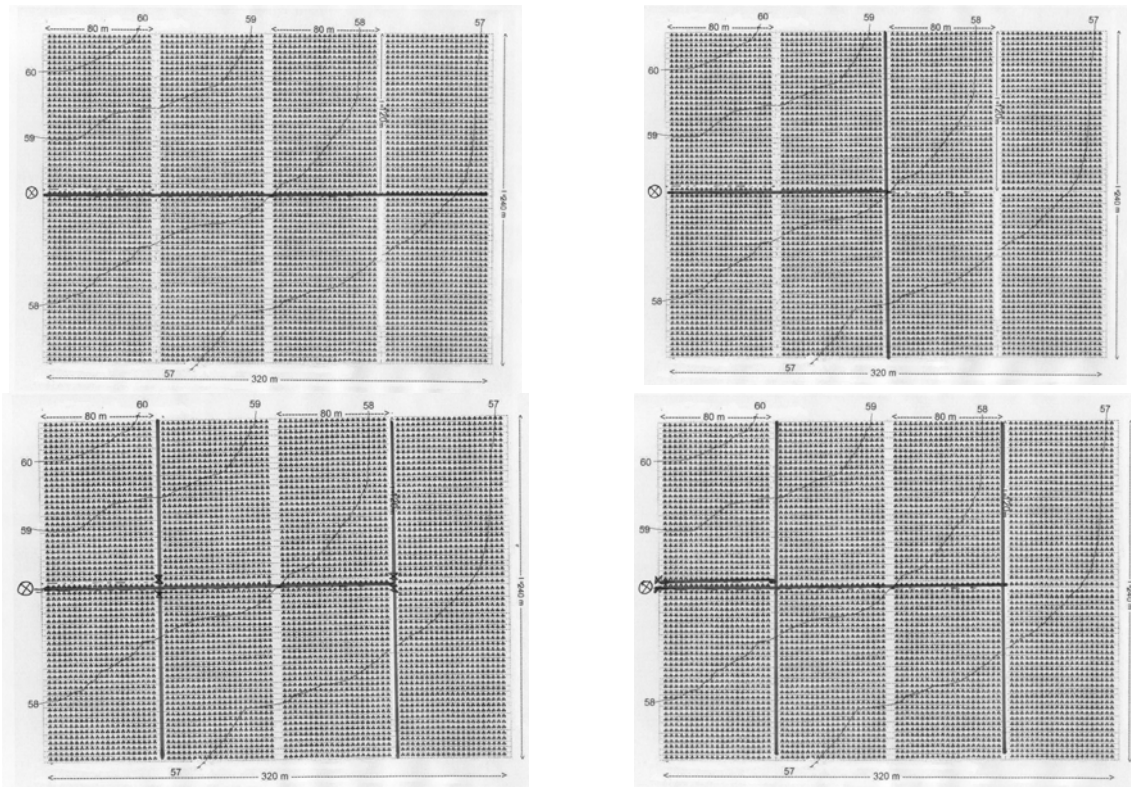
Plan d'un système de goutte-à-goutte Adapté de la brochure Watermatics
